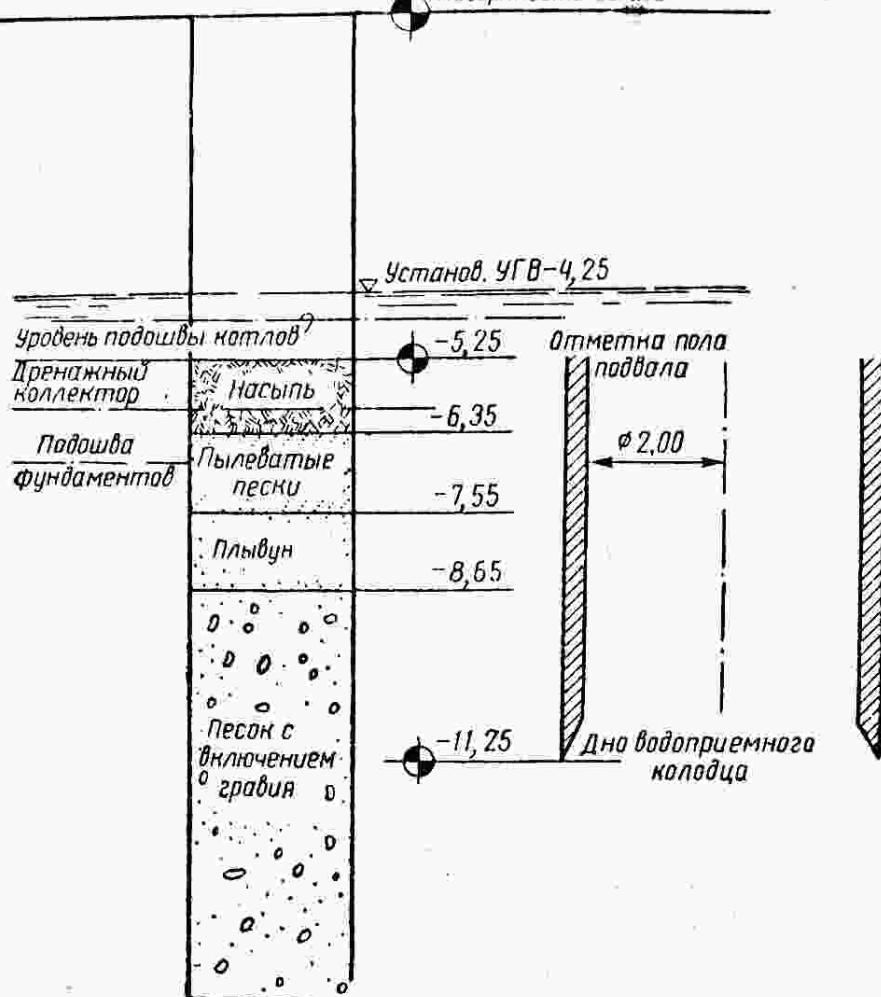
Расположение коллекторов и водоприемного колодца в подвале бани и геологический разрез грунта
